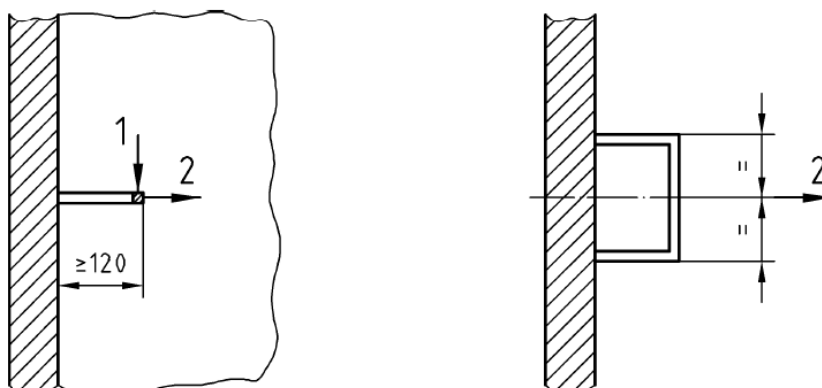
Dispositif d'essai pour le chargement vertical et l'arrachement horizontal
